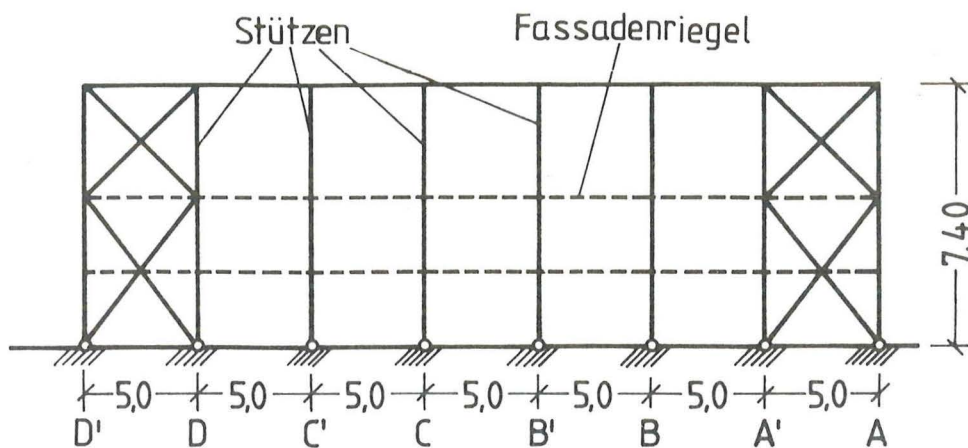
Randstützen der Halle mit Stabilisierungsverbänden
